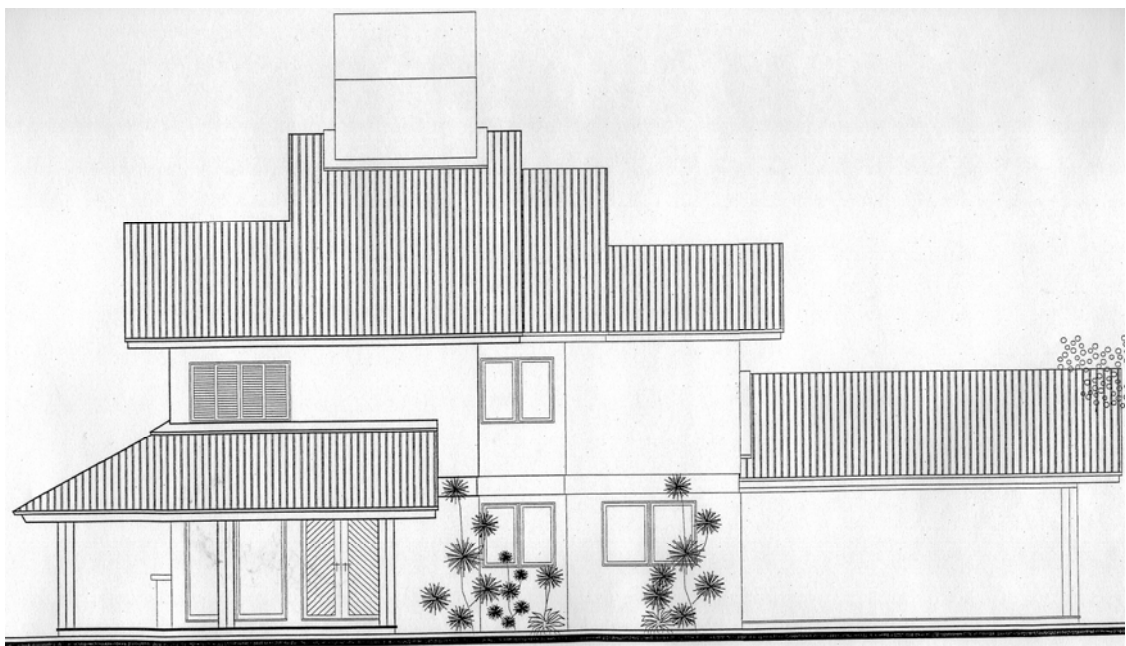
Projeto Estudo de Caso 1 - Fachada Oeste
